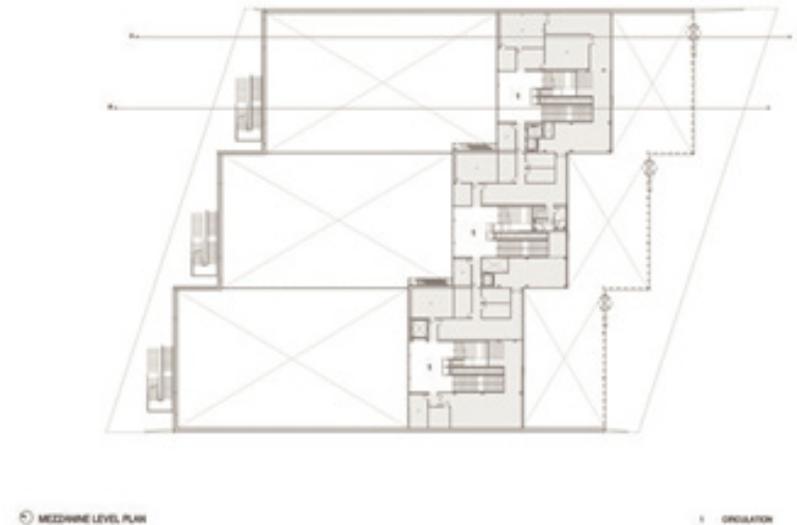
Planta del Centro de Exhibiciones / Owensboro, Estados Unidos (ArchDaily, ArchDaily, 2016)
